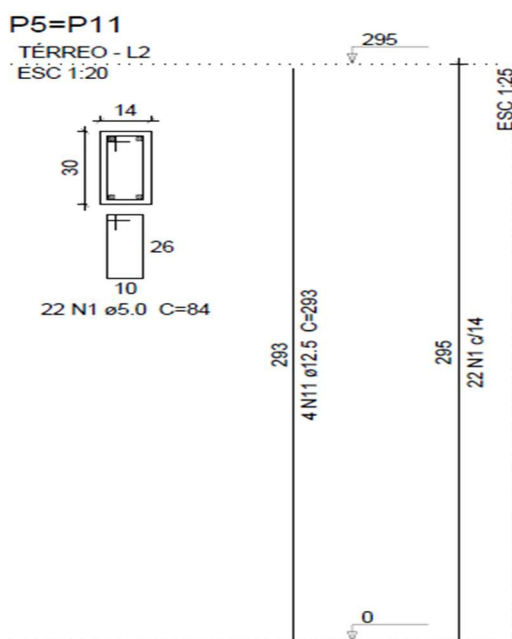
Seção de aço dos pilares e detalhes da armadura long/trans.
